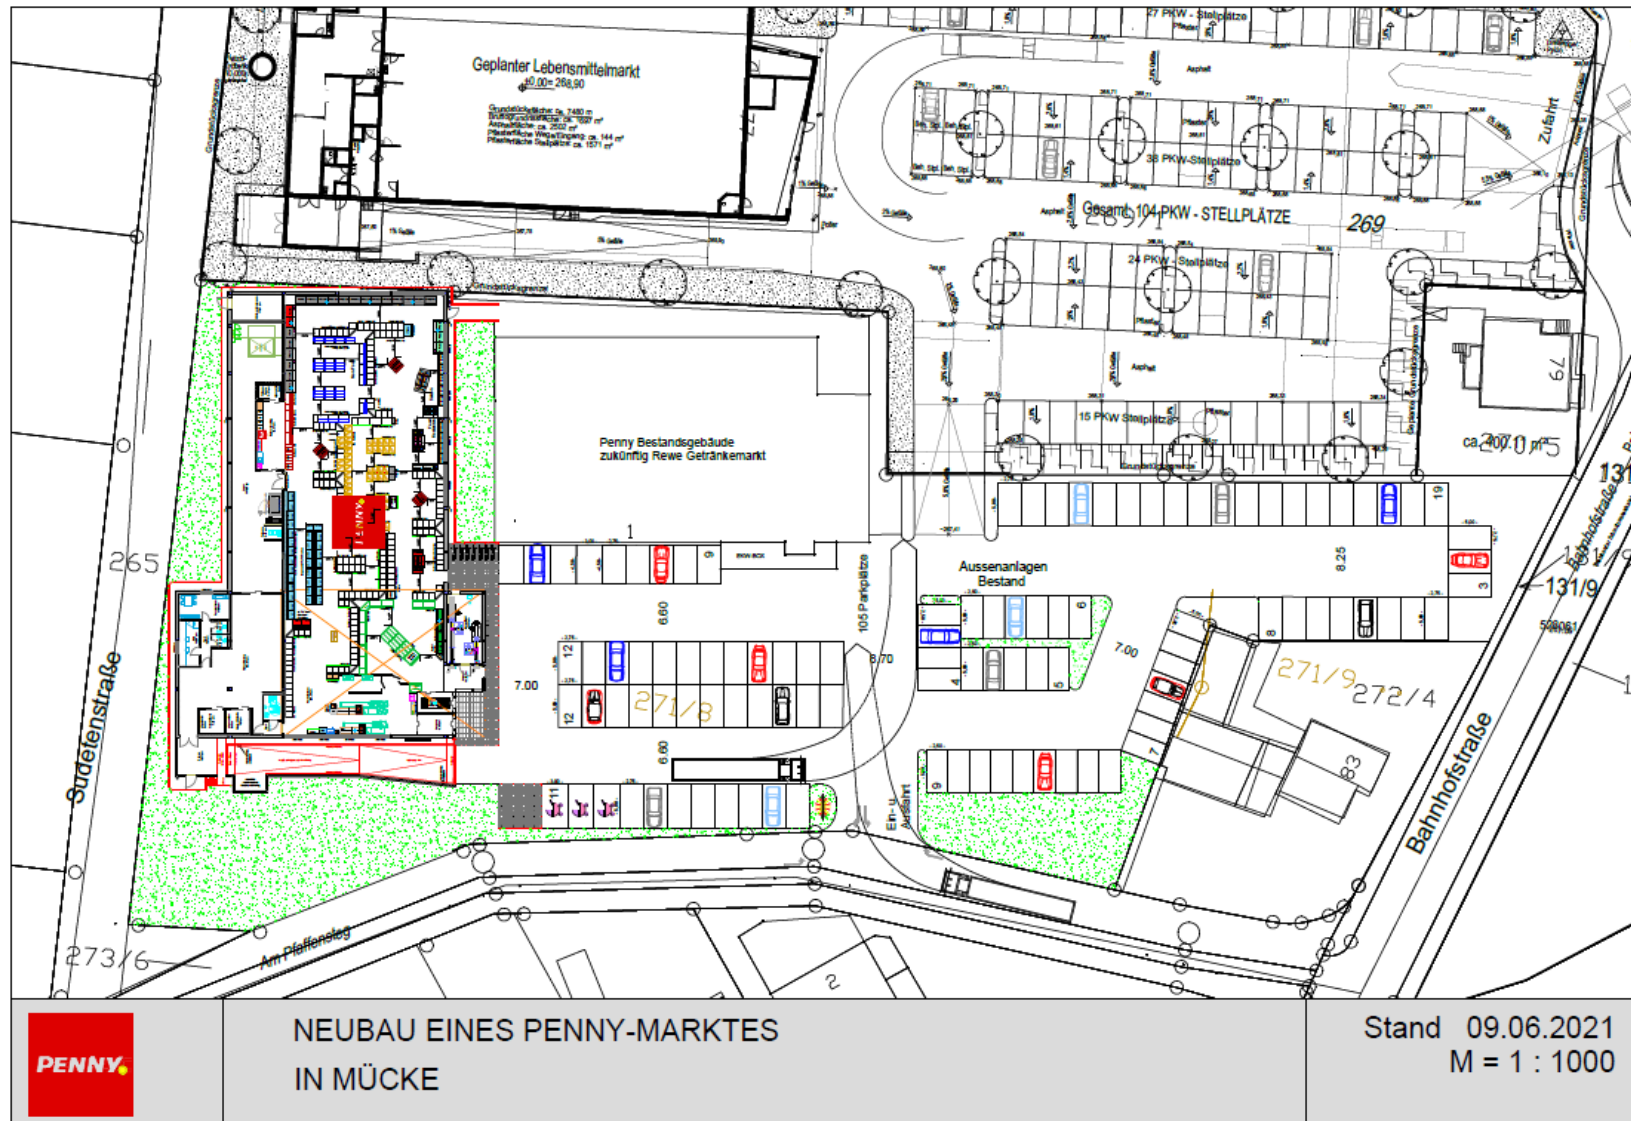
Lageplan des Vorhabenstandortes in Mücke
